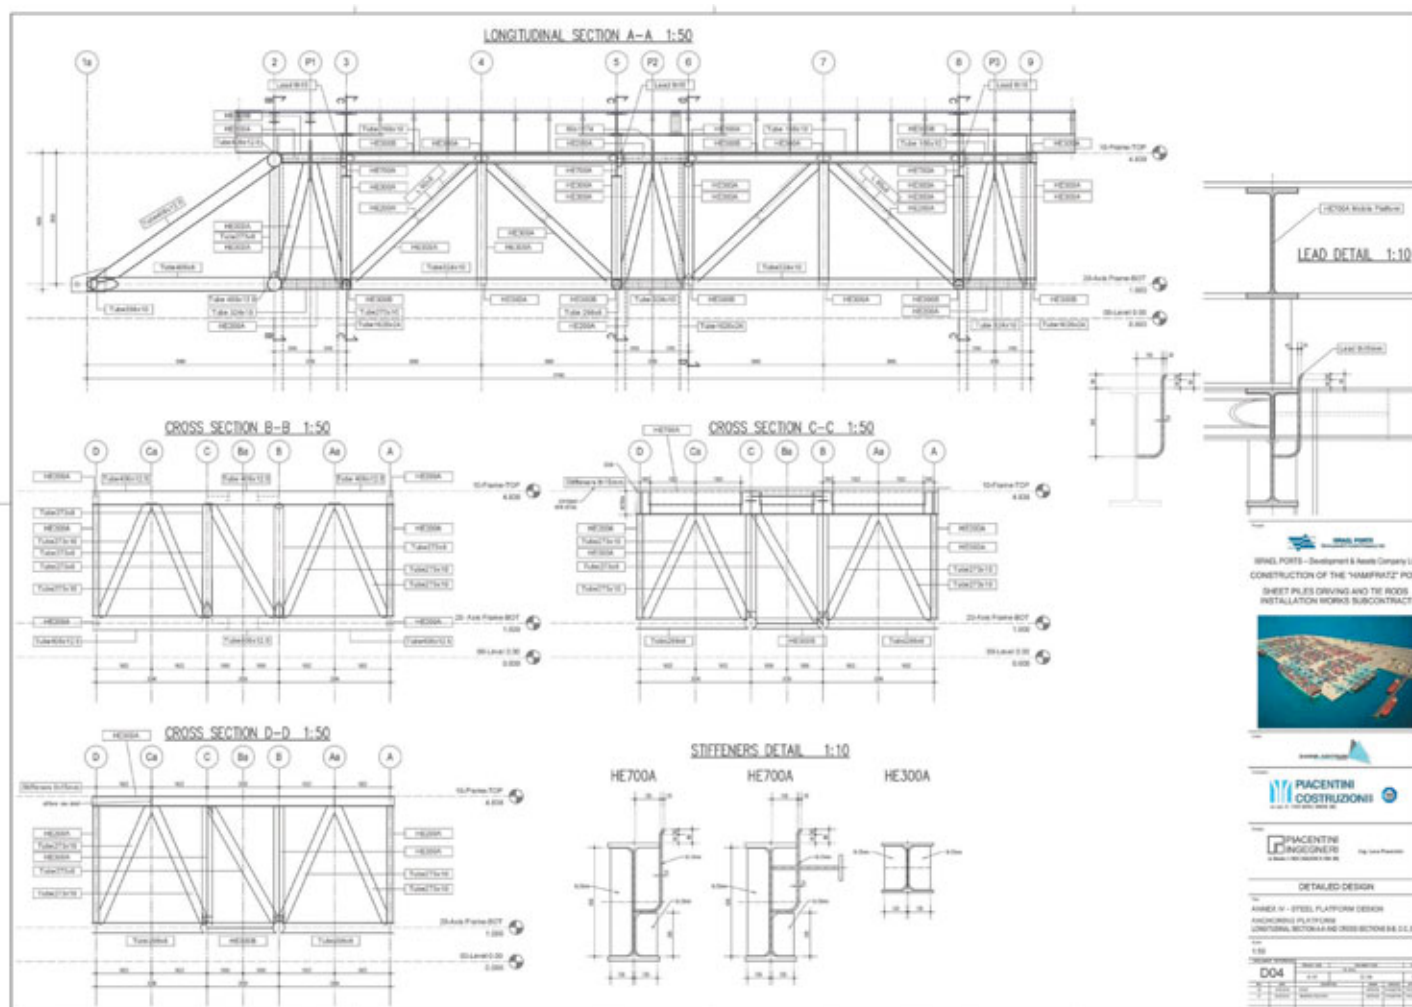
Sezioni longitudinale e trasversali del modulo reticolare
